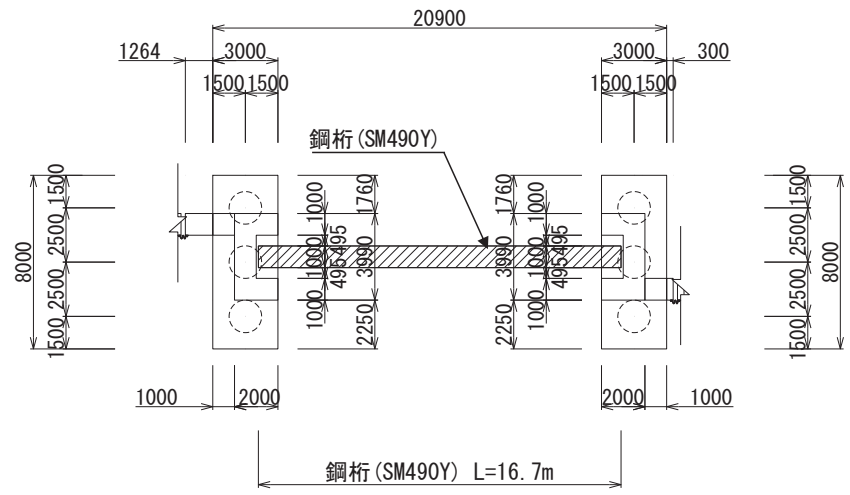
(2) 鋼製遮水壁 (鋼桁 2) 平面図
